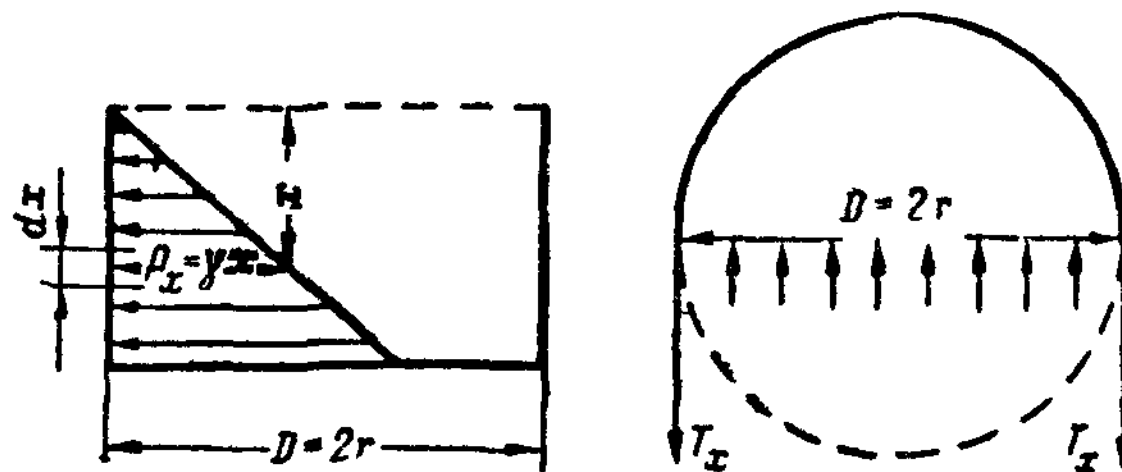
К расчету стенки корпуса вертикального цилиндрического резервуара
